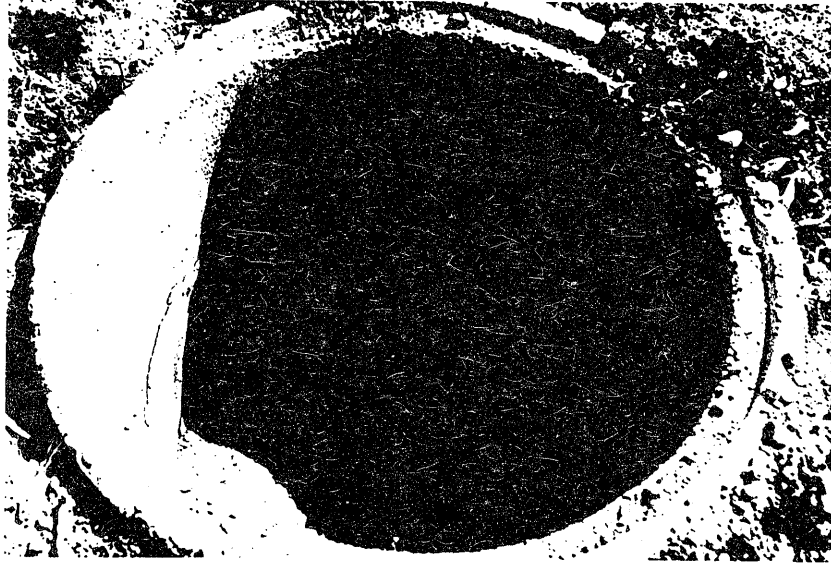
Taban betonu hazırlanmadan beton halkalar üst üste konularak oluşturulmuş bir muayene bacası.
